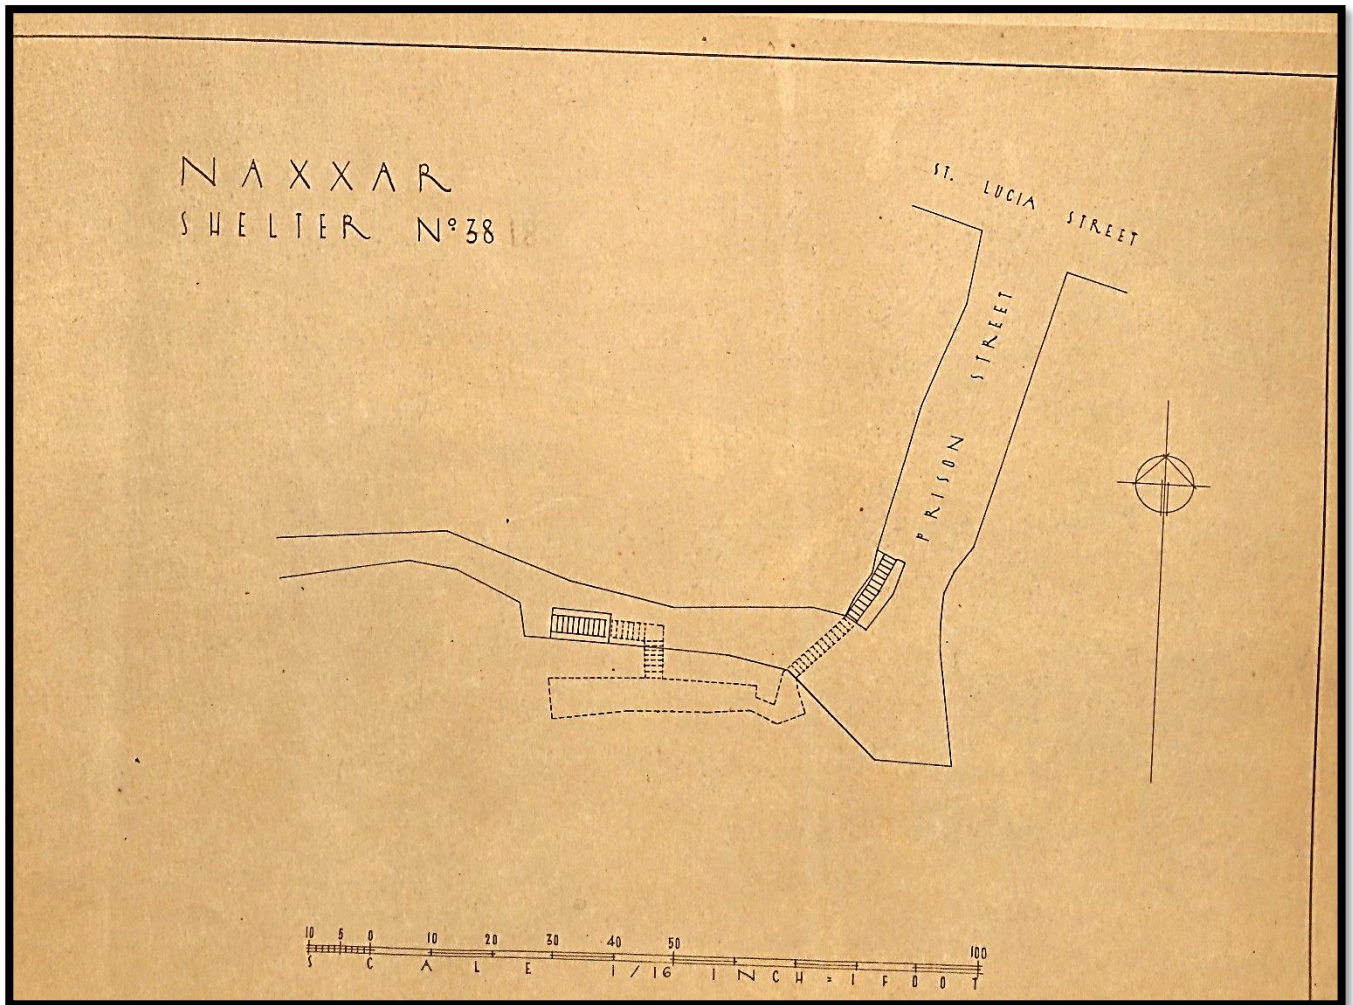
Planta do Abrigo nº38 (18) "Prison Street – St. Lucia Street."
